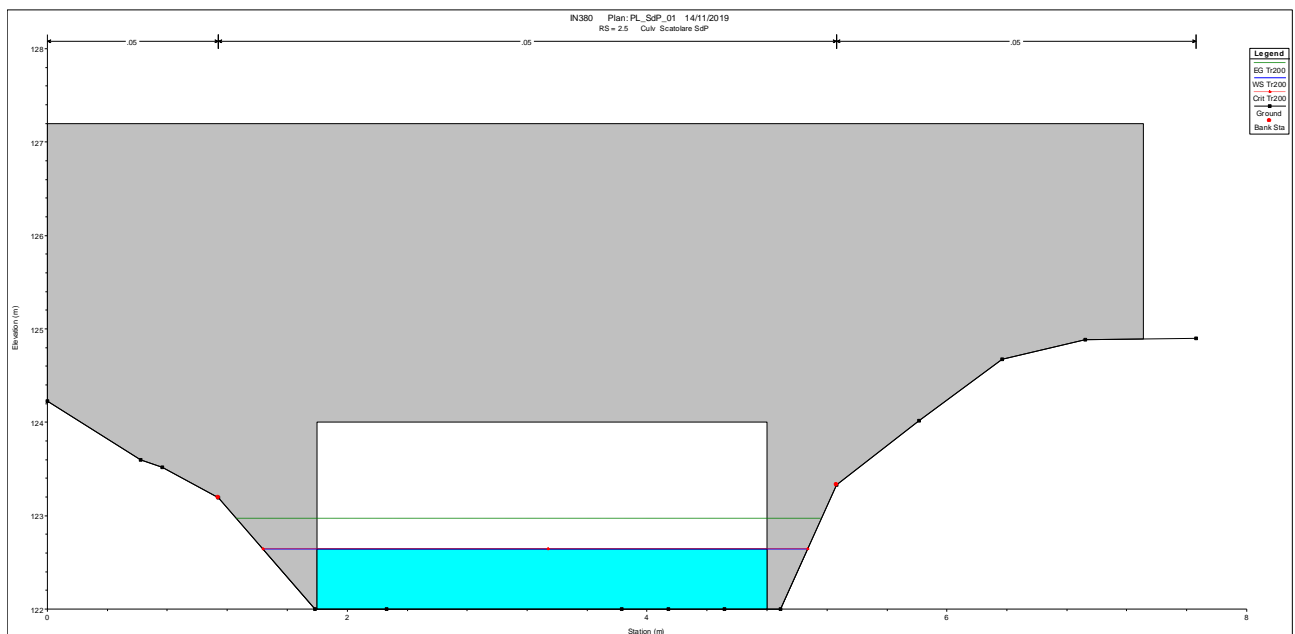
Sezione valle manufatto – stato di progetto interferenza IN380.
